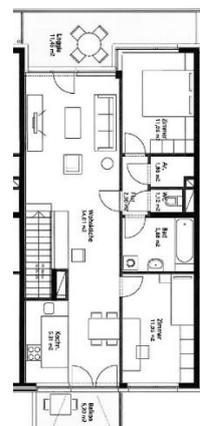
3-Zimmer Wohnung mit Koch-/Essbereich und Balkon zum Hof, Bauteil C Ganahl Iftsits Larch Arch.
